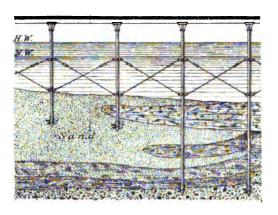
Landungssteg auf Schraubenpfählen. M. 1:400.
